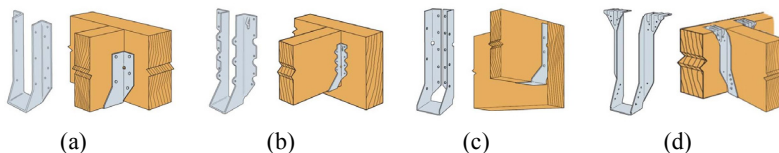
Tipos de suportes metálicos para ligação entre vigas de madeira (adaptado de STRONGTIE, 2008).
